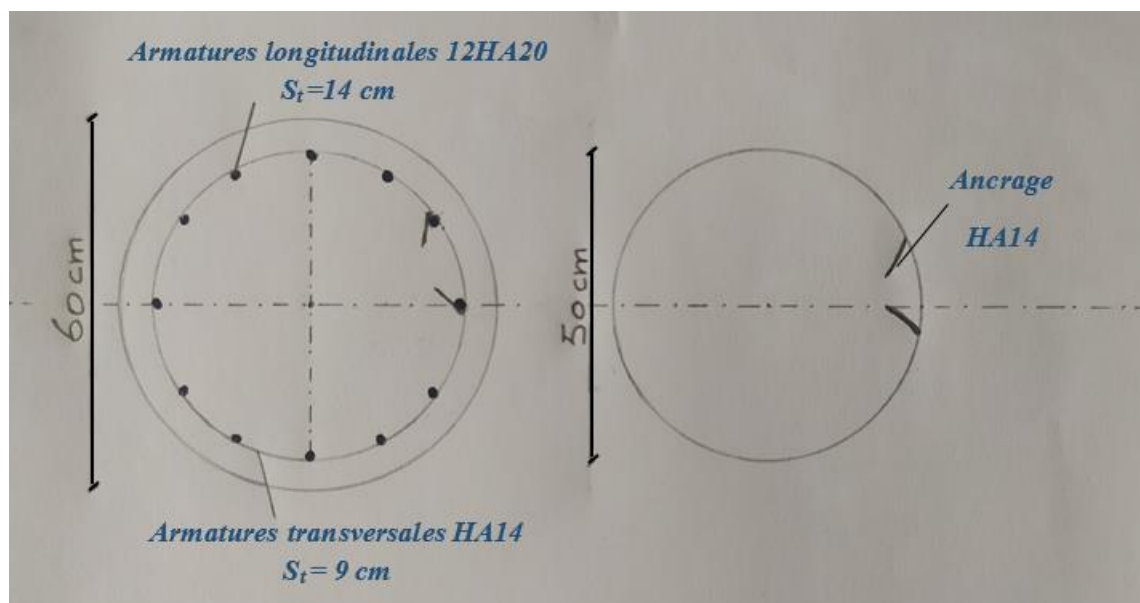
Ferrailage du pieu au niveau des zones critiques.
